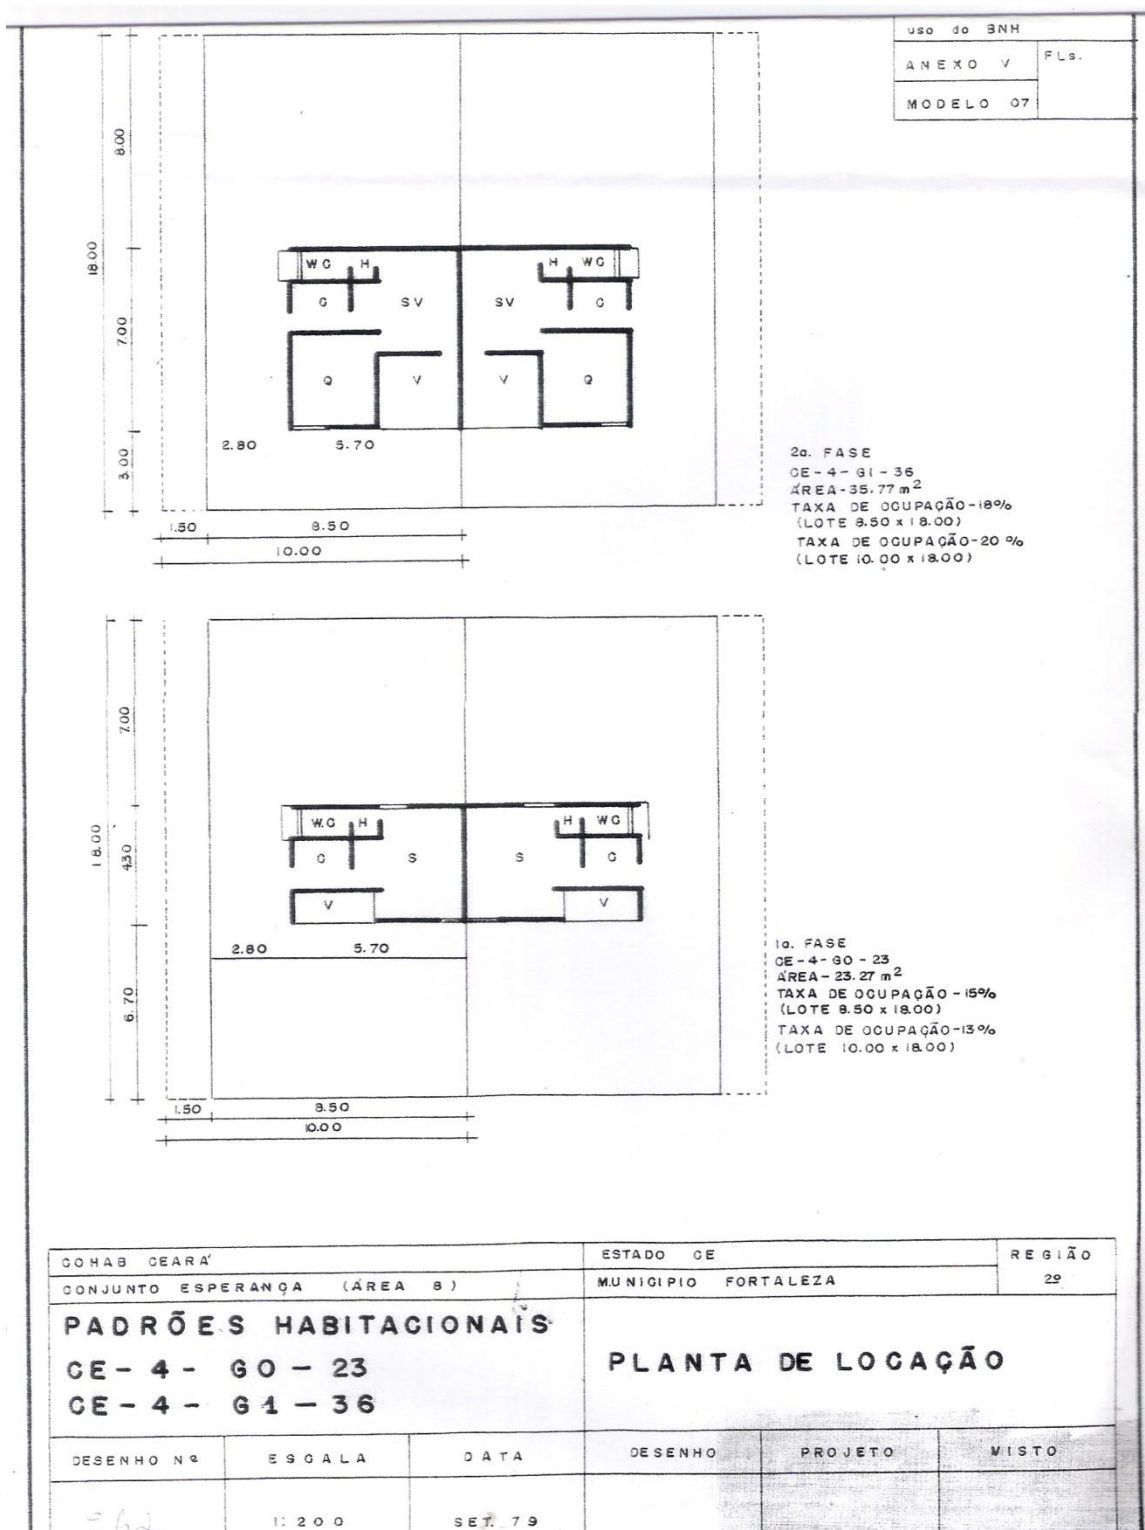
Planta da casa tipo A e B, cedida pela COHAB.
